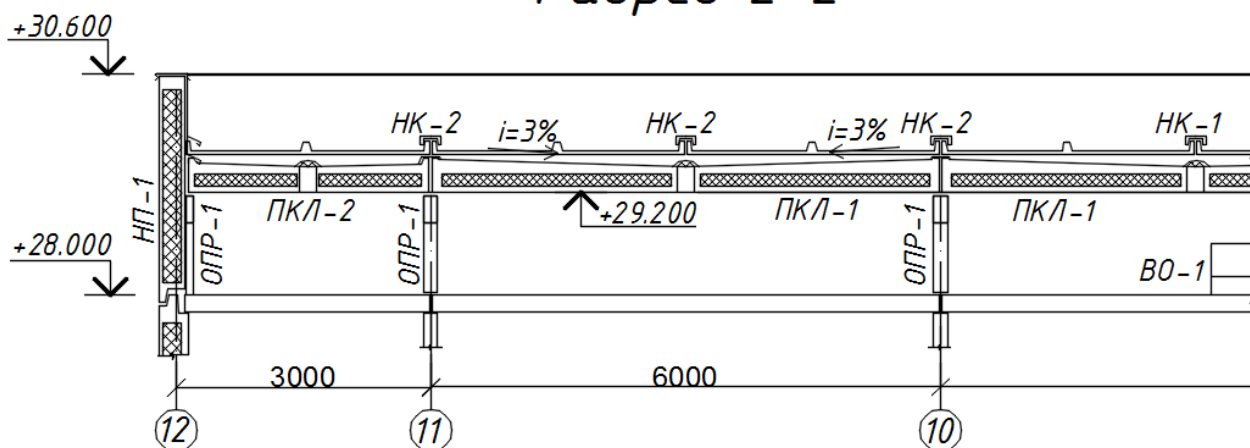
Теплый чердак и безрулонная кровля. Продольный разрез:
